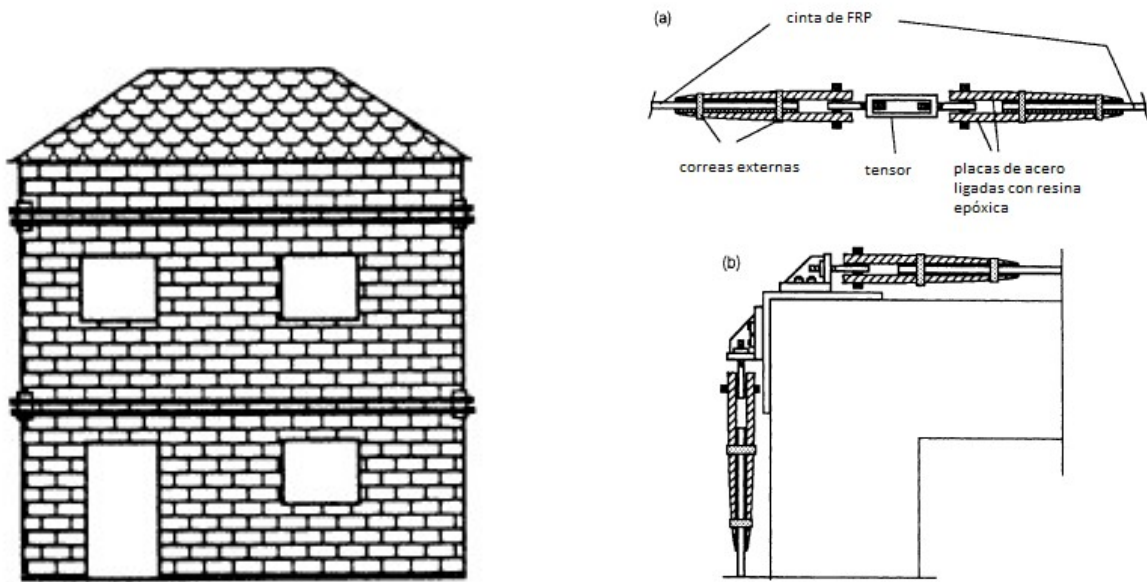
3- IZQUIERDA: aplicación externa de las correas de FRP; DERECHA: a) anclaje propuesto para estructuras circulares; b) anclaje propuesto para esquinas de edificios de mampostería. (Triantafillou T. y Fardis M., 1997).
